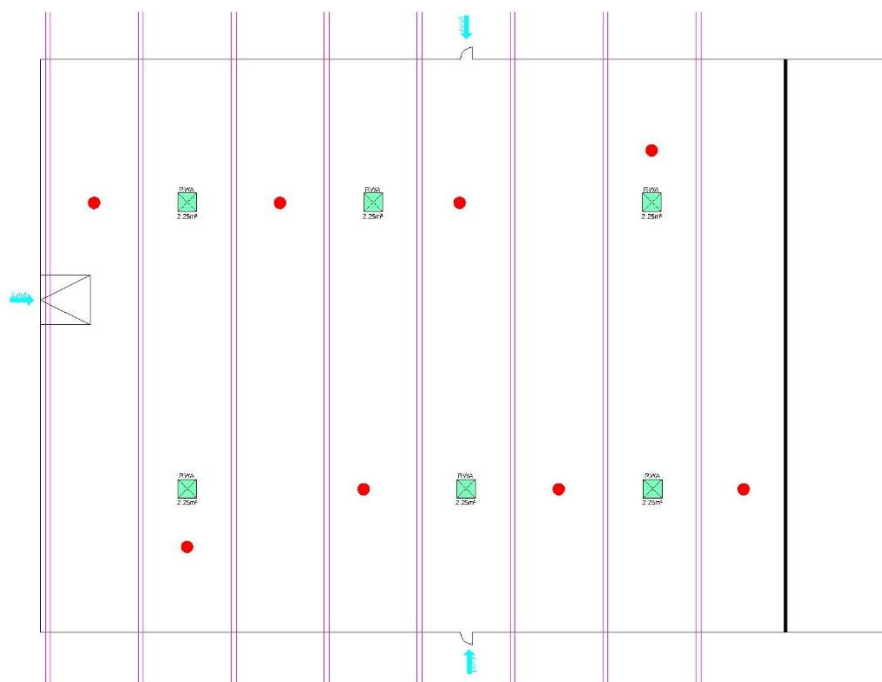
Schematischer Grundriss der Halle mit Einbindung der RWA und Zuluftflächen sowie Rauchmelder (eigene Darstellung)
